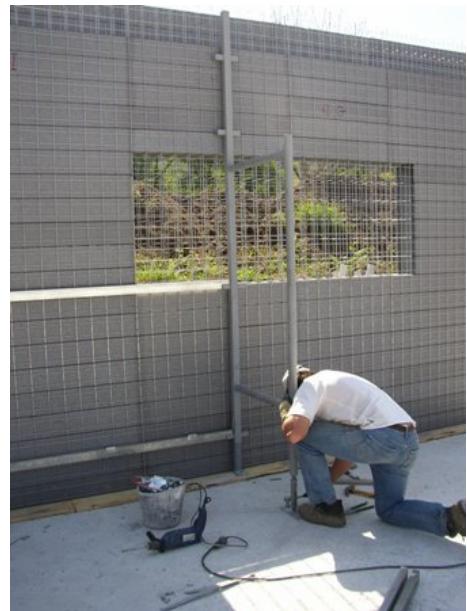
Pormenor da construção das paredes e negativo para a janela.
